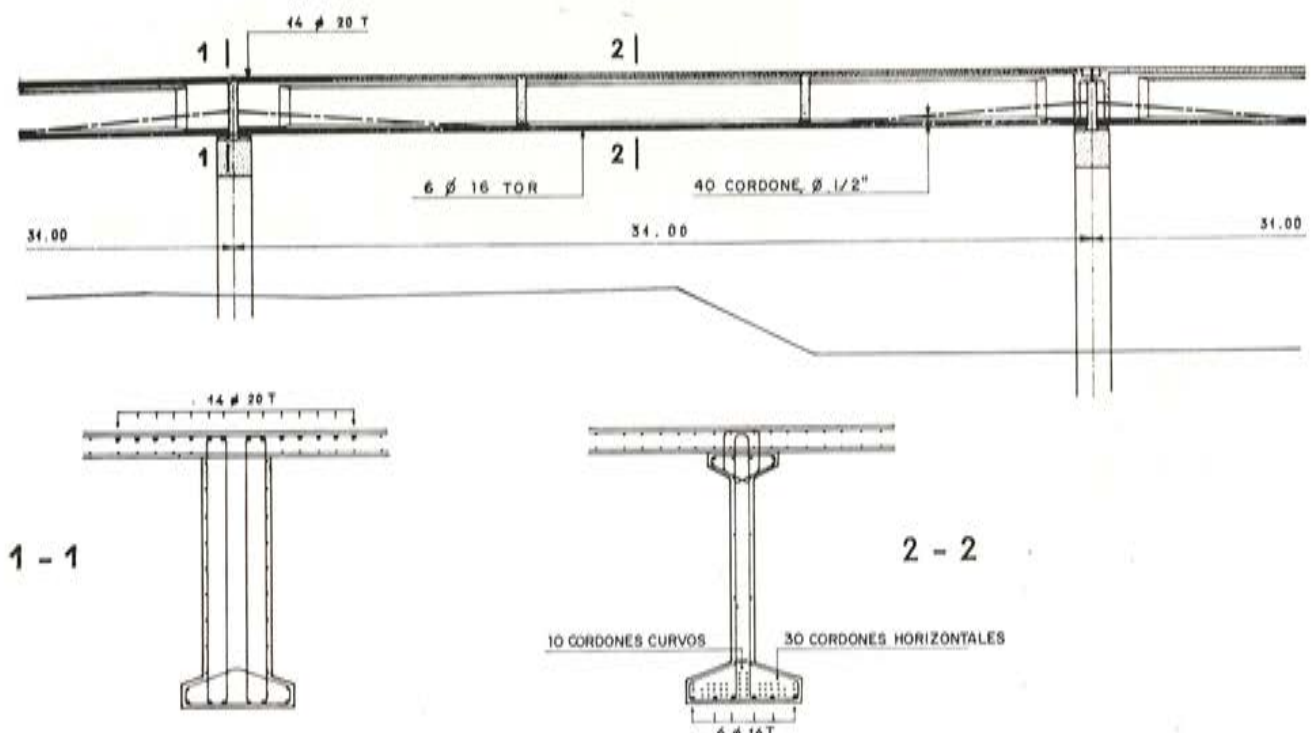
Viaducto S2. Tramo normal. Trazado de cables y distribución de armaduras.
